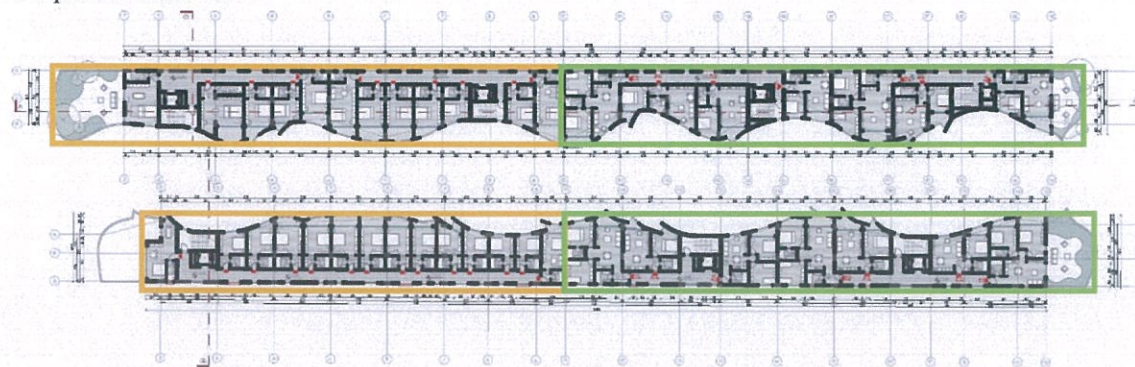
Planimetria e Katit të Tretë _HOTEL DHE APART - HOTEL
